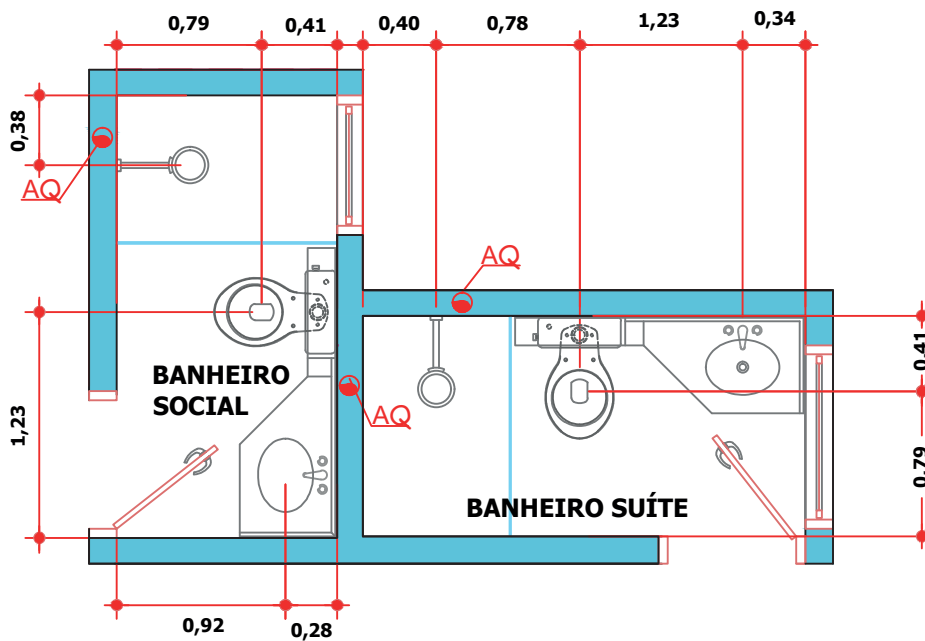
Instalação Hidráulica - ÁGUA QUENTE
